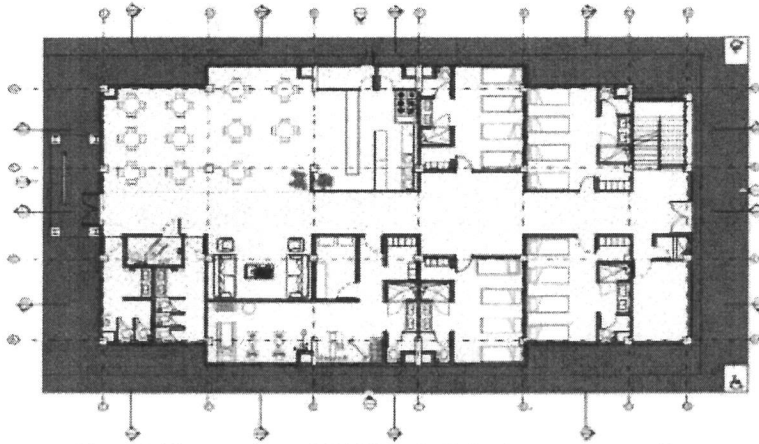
Vista en planta del Edificio de Alojamiento para guardias
